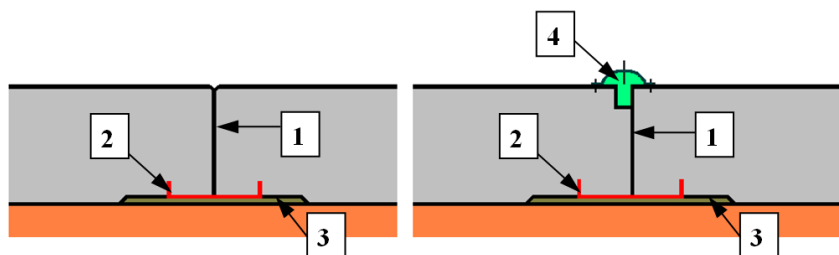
Устройство «узких» вертикальных швов в железобетонном экране
